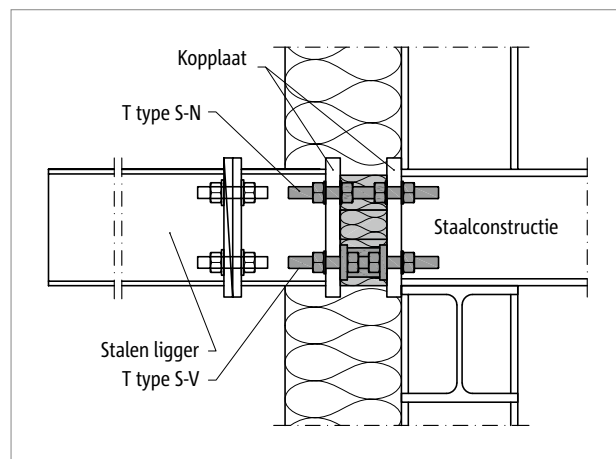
Schöck Isokorf® T type S-V: ondersteunde staalconstructie
